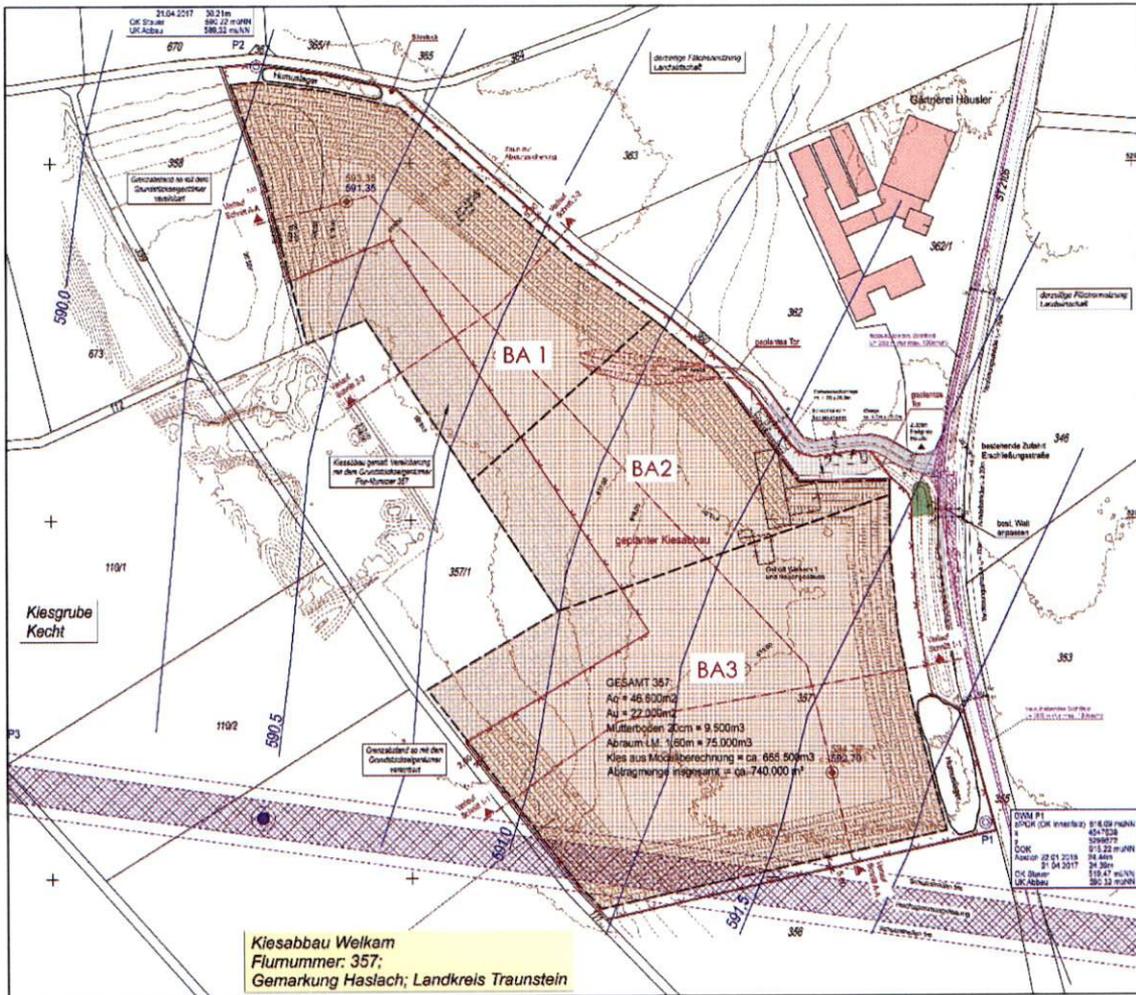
Lageplan mit Darstellung der geplanten Abbaufäche (Abbauplan)
